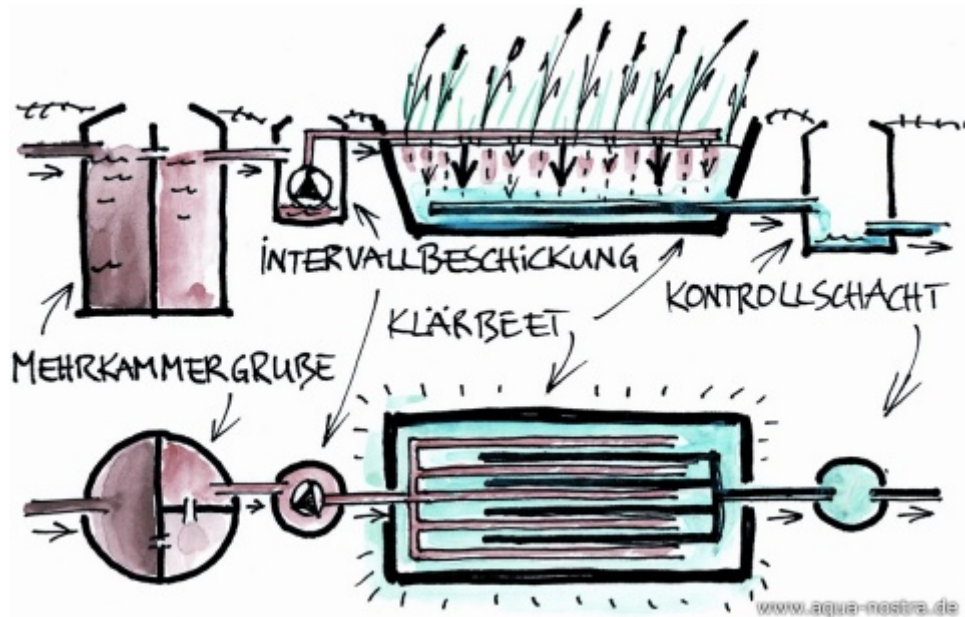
Schema einer vertikal durchflossenen Pflanzenkläranlage mit Vorklärung, bepflanzen Bodenfilter und Kontrollschacht¹
